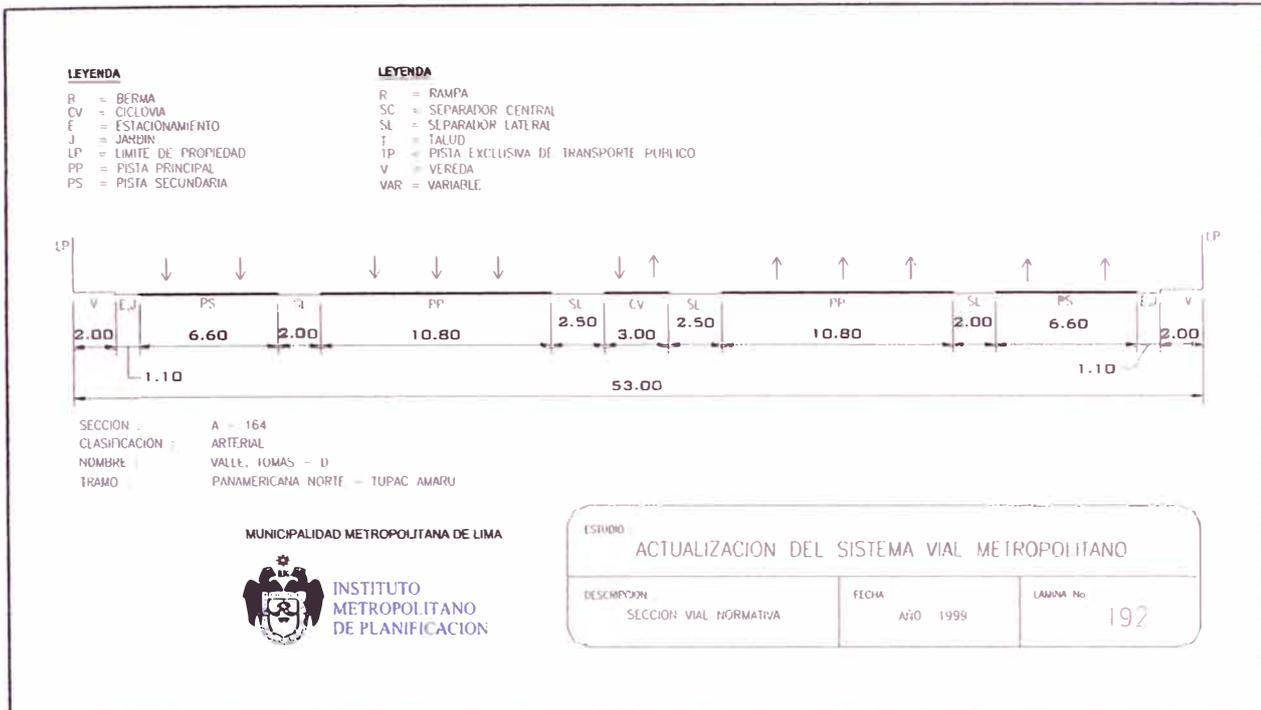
Sección Vial Tomas Valle tramo Panam. Norte Germán Aguirre
